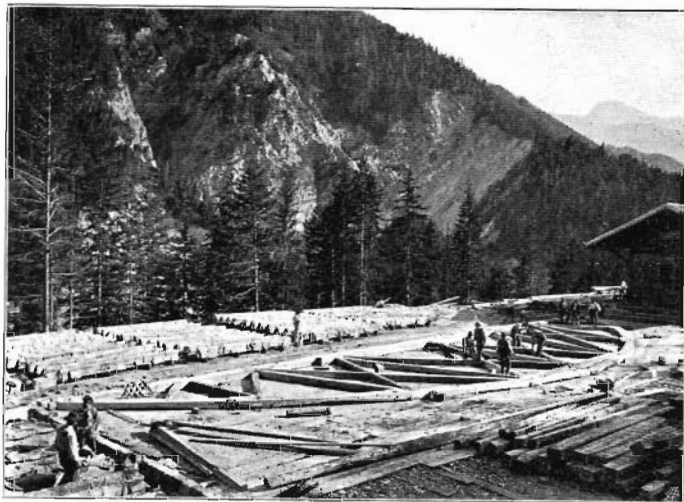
Reissboden für die Lehrgerüst-Binder auf dem Stationsplatz Wiesen.
